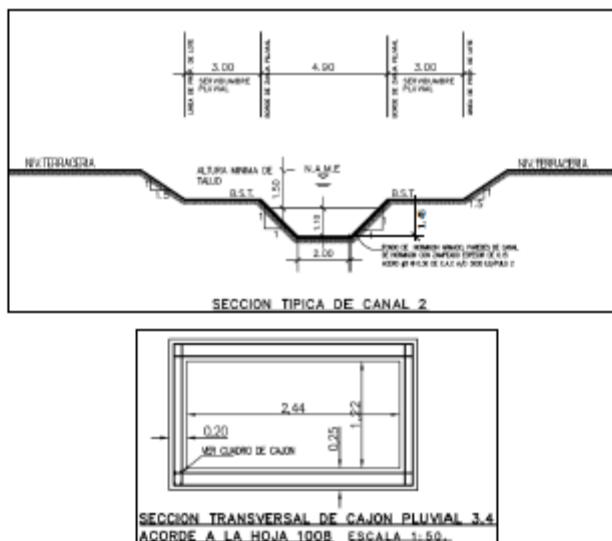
Secciones transversales óptimas conformadas en concreto, propuesta para el drenaje pluvial "Sin Nombre 2"
